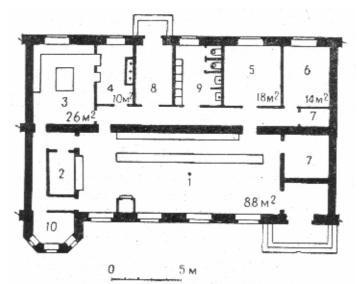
Домовая кухня в жилом доме (СССР) I—торговый зал; 2 — продажа мясных полуфабрикатов; 3 —варочный цех; 4—мойка; 5 — заготовочный цех; 6 — холодный цех; 7 — кладовые; 8 — загрузка товаров; 9 — гардероб персонала и санитарный узел; 10 — помещение администратора
